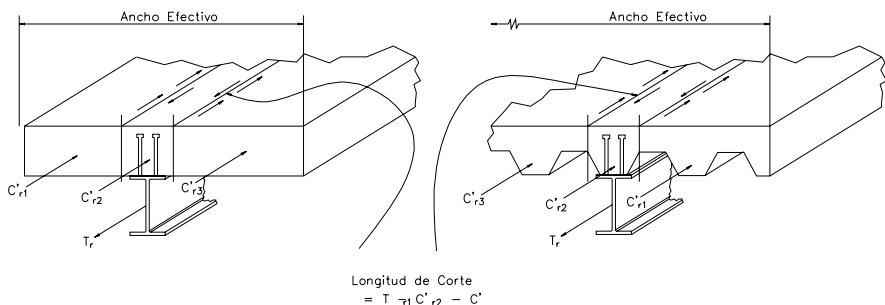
Corte longitudinal en la losa [según Chien y Ritchie (1984)].
